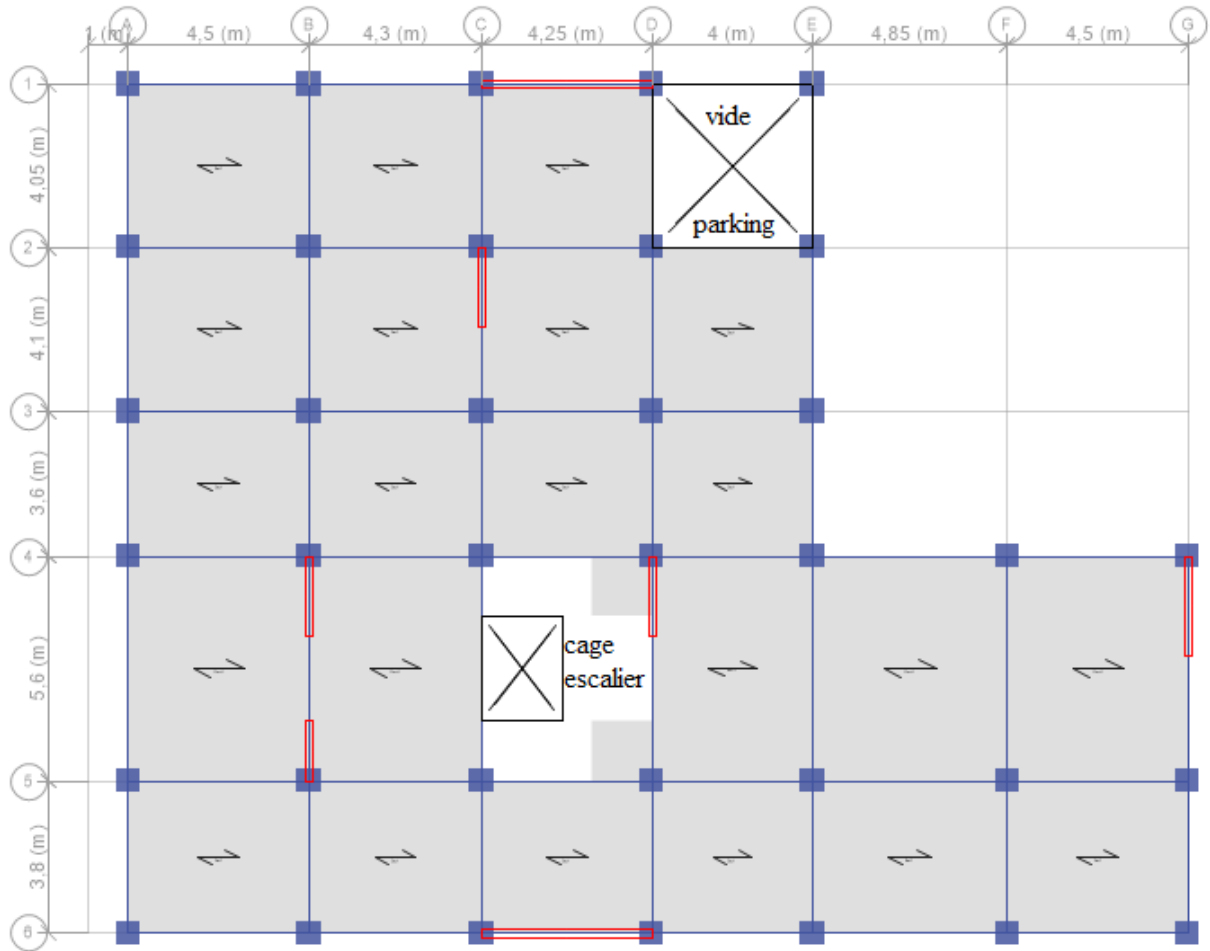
Schéma de la disposition des poutrelles pour RDC.
